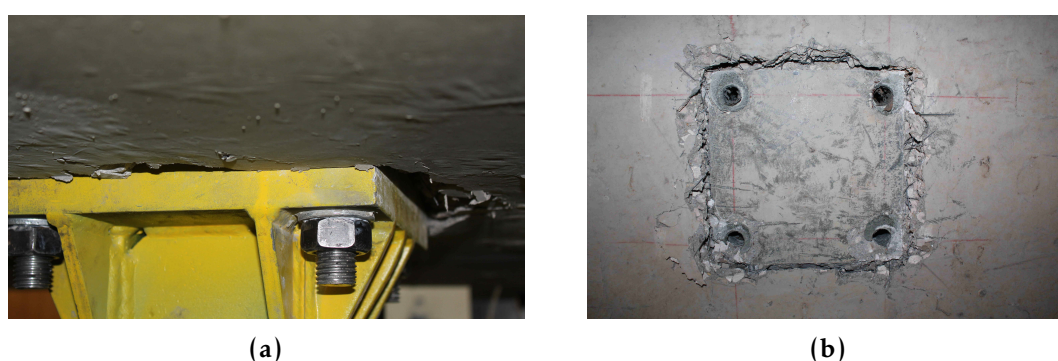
Fotos da face inferior da laje após rotura: (a) entrada do pilar na laje durante o ensaio no modelo F0.5_4D e (b) vista inferior sem o pilar no modelo F0.75_4D.
